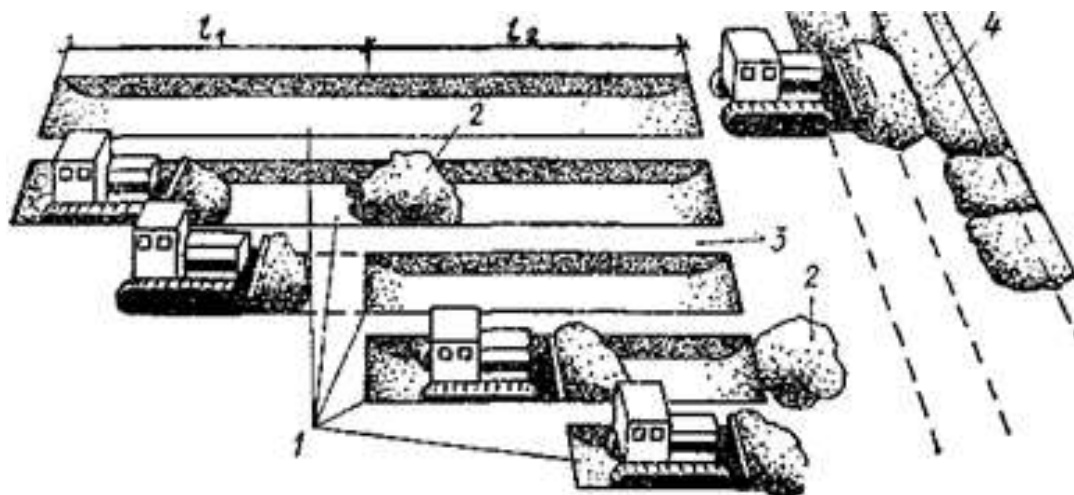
Траншейный способ разработки грунта при отсыпке насыпи: 1 — траншеи проходок бульдозера; 2 — промежуточные валики; 3 — перемычка между траншеями; 4 — насыпь.
